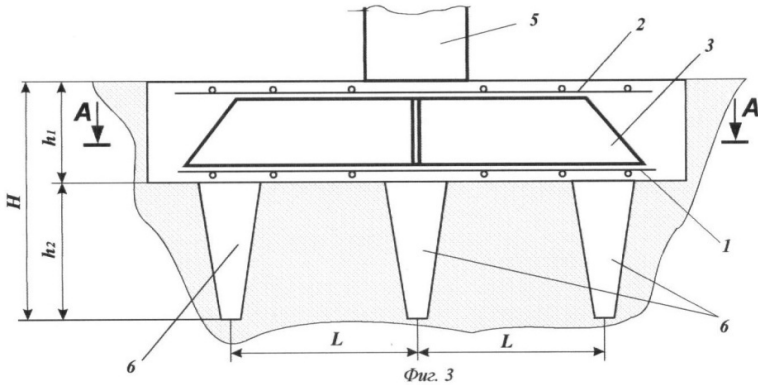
Размещение опорной части фундамента на вытрамбованных участках грунта, колонна круглая [3] где: 1 – верхняя арматурная сетка; 2 – нижняя арматурная сетка; 3 – жёсткие вставки; 5 – колонна; 6 – вытрамбованные участки грунта.
